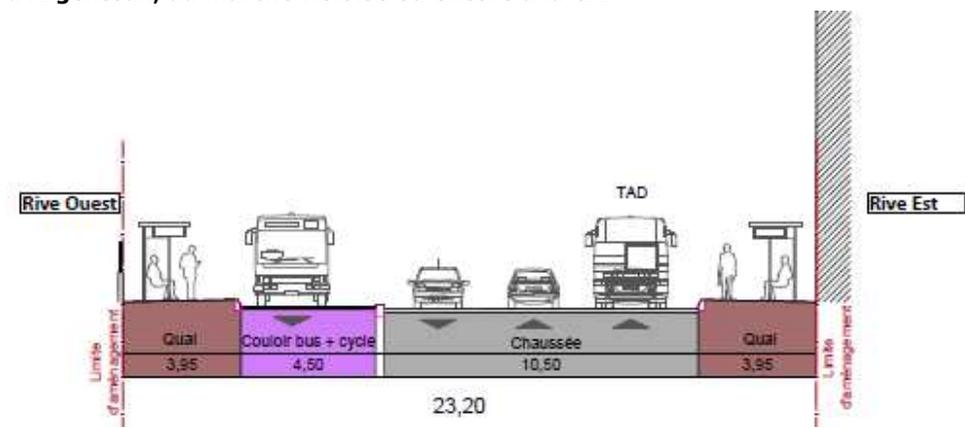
Coupe type en station sur l'avenue du Général De Gaulle
